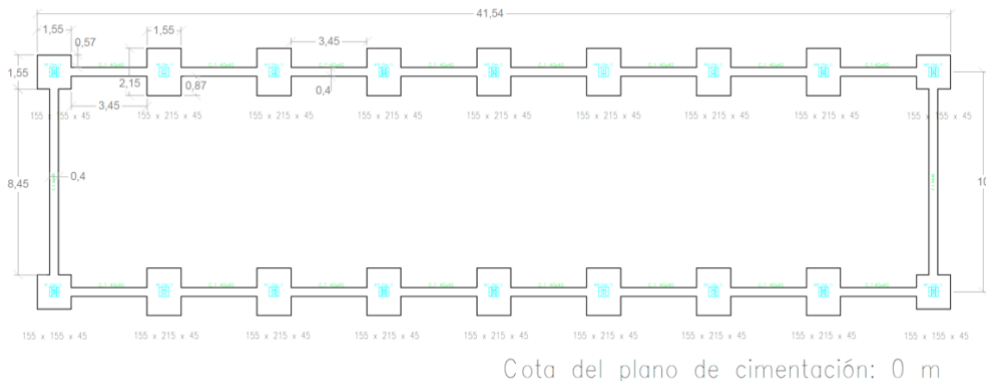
Planta de la cimentación y placas de anclaje. Fuente: CYPE 3D.
